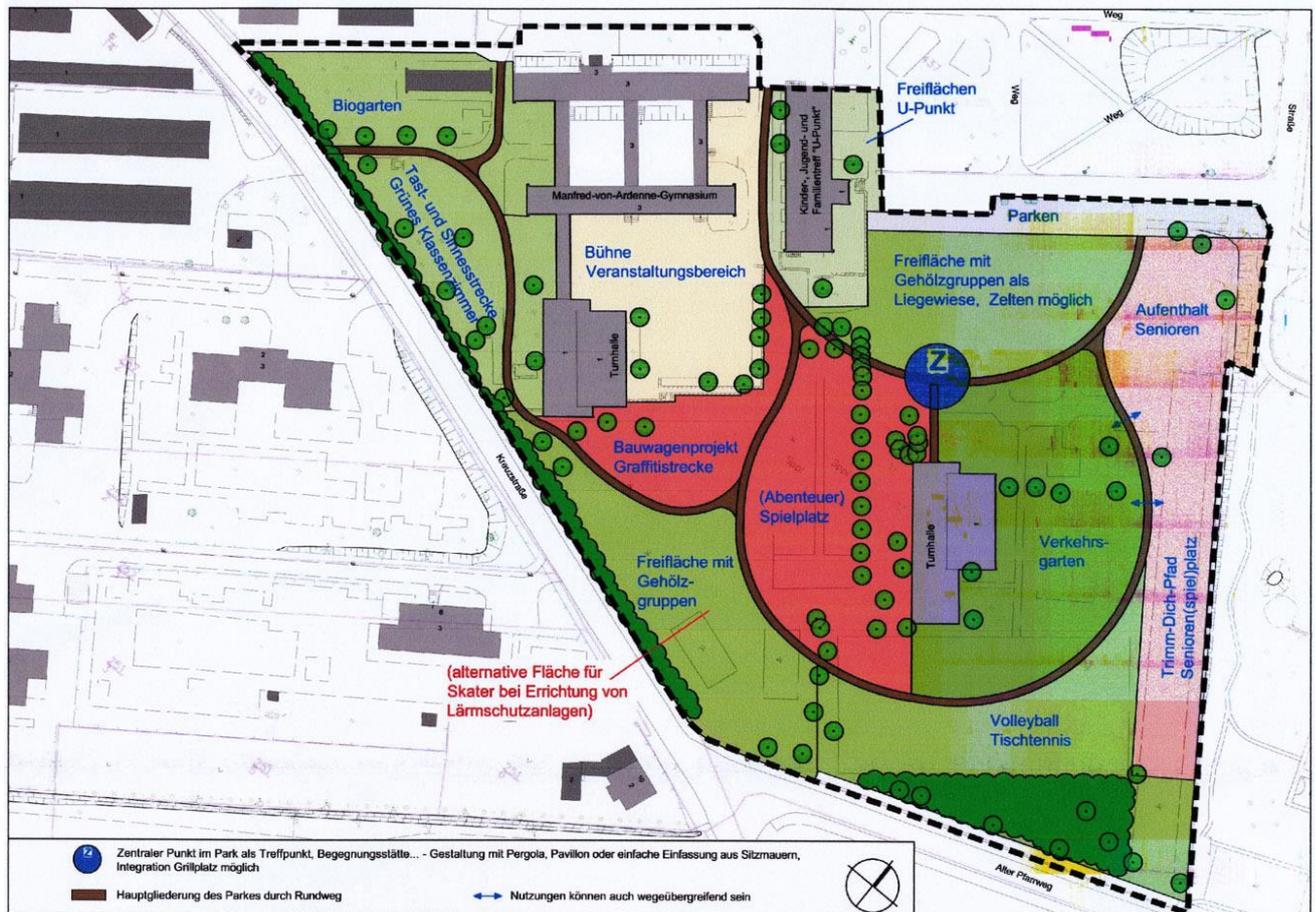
Bürgerpark – Entwurf Vorzugsvariante
